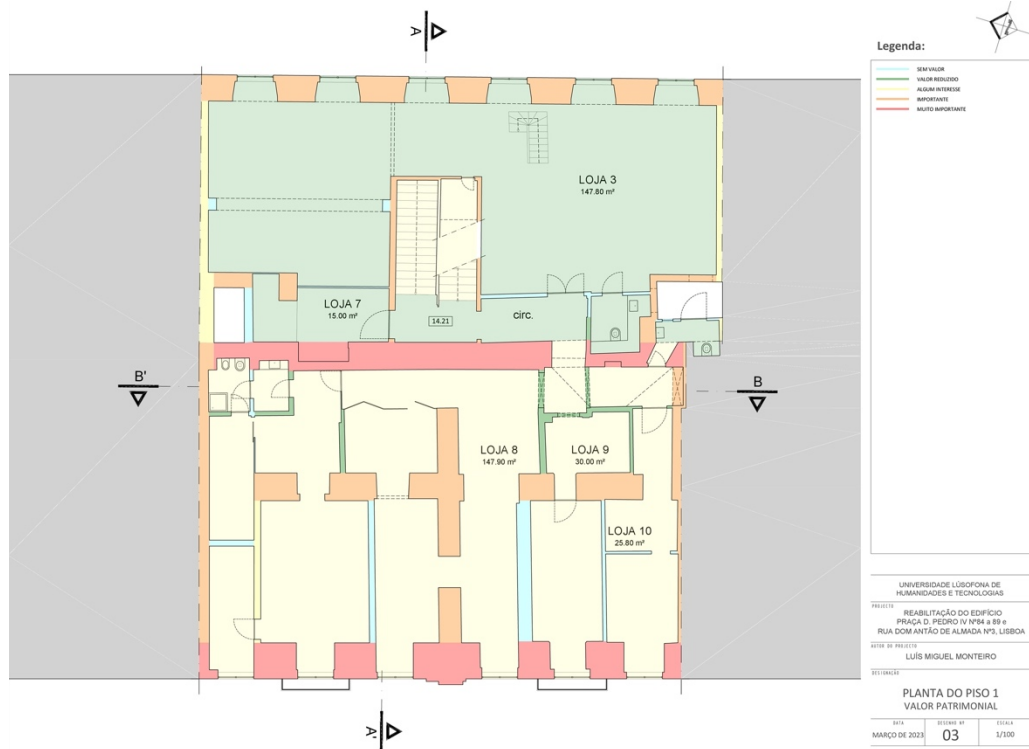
Planta do primeiro andar; valor cultural relativo dos elementos arquitetónicos do edifício.
